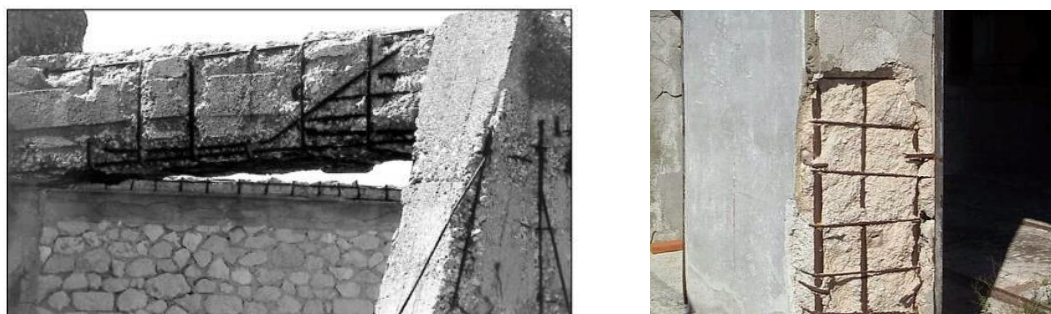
Fissuration d'un poteau et une poutre en béton armé en milieu salin. [(Yahiaoui S).2006]
